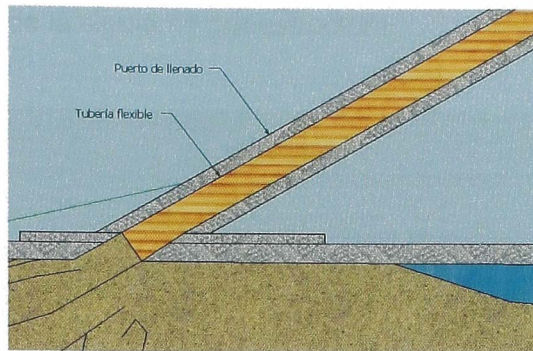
Tubería de llenado dentro del puerto de llenado de la geoestructura.
